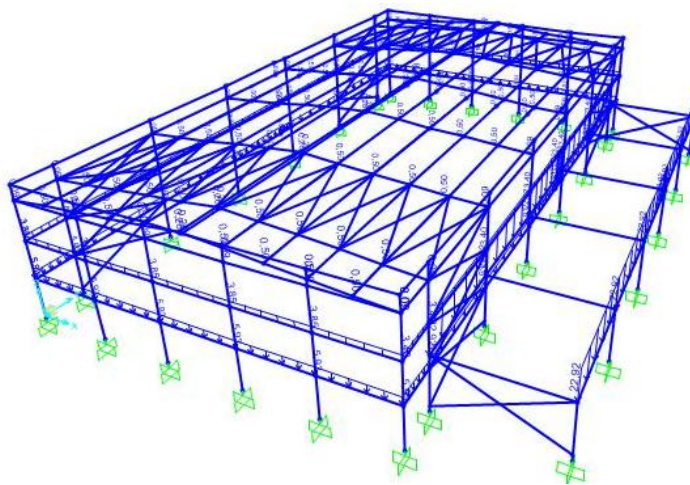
Estructura bajo la acción de cargas muertas (SAP2000)
